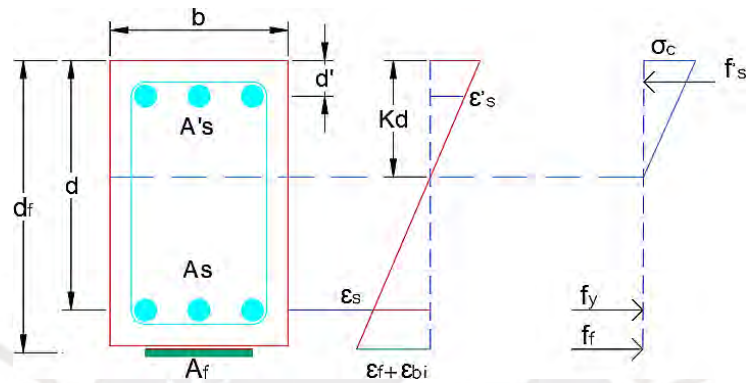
Viga de concreto armado externamente reforzada en el límite elástico por flexión.
